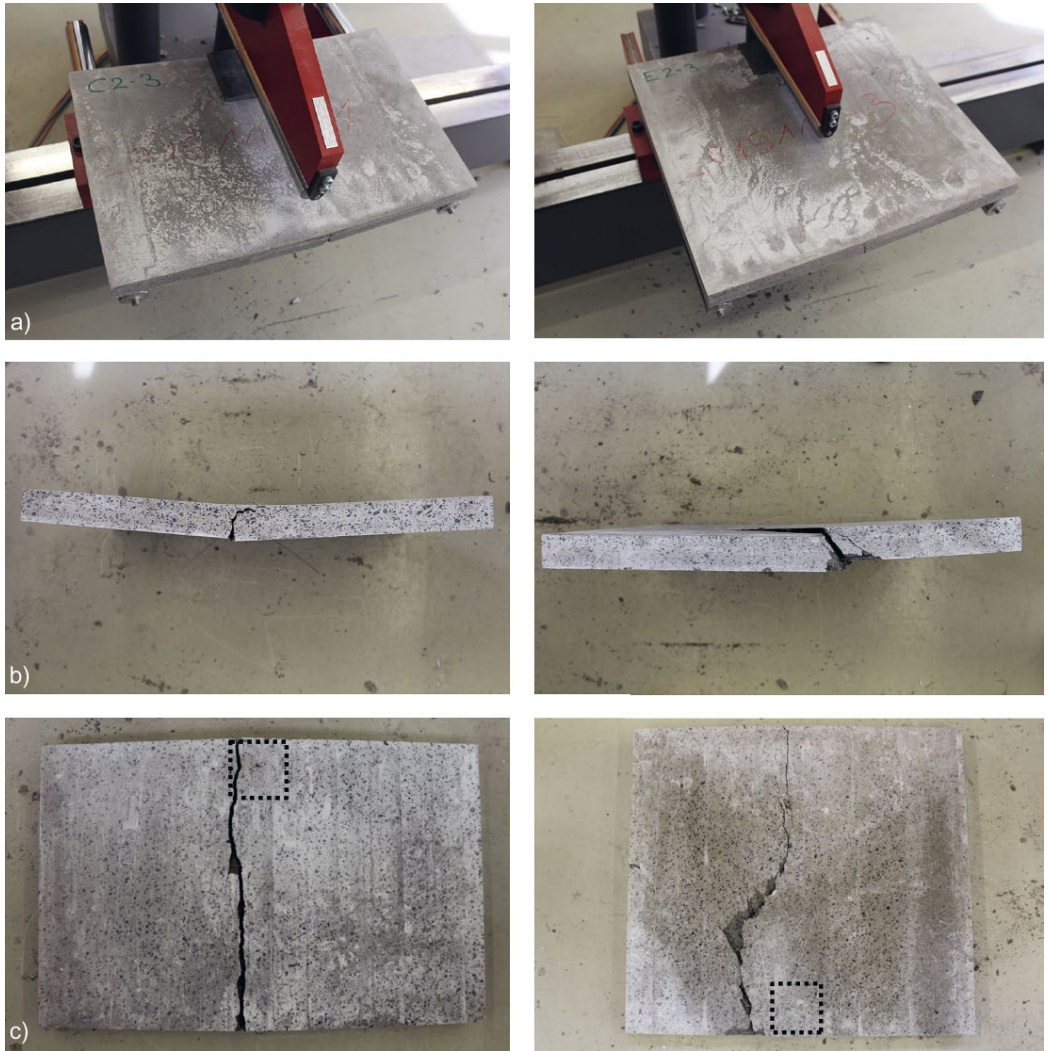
Links: 350 mm breiter Prüfkörper C2-3 mit Biegeversagen; a) Prüfkörper bei Bruch; b) Seitenansicht nach Bruch, Oberseite ungerissen; c) Unterseite nach Bruch mit typischem Biegeriss; rechts: 500 mm breiter Prüfkörper E2-3 mit Biegeversagen; a) Prüfkörper bei Bruch; b) Seitenansicht nach Bruch, Oberseite angerissen; c) Unterseite nach Bruch mit typischem Biegeriss
